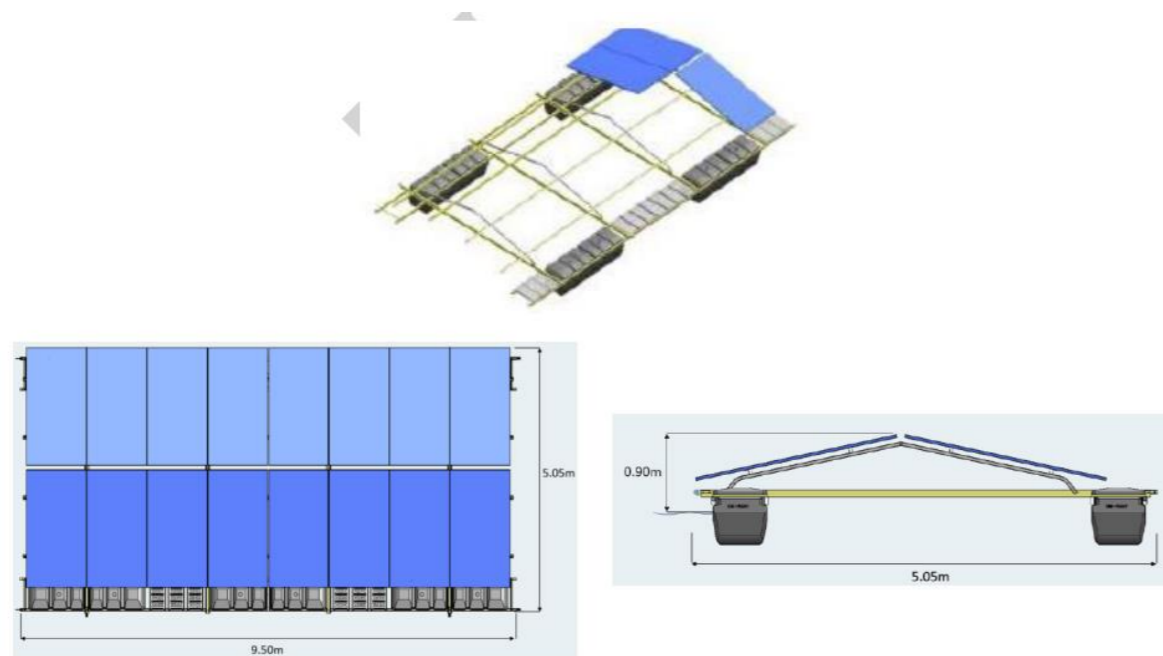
Technologie ponton – Dimensions d'une structure flottante
